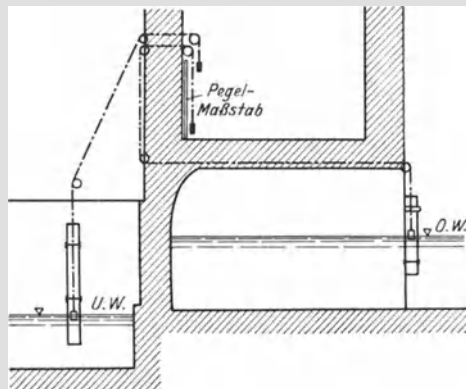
Schwimmerpegel für Ober- und Unterwasser an einer Staustelle.
